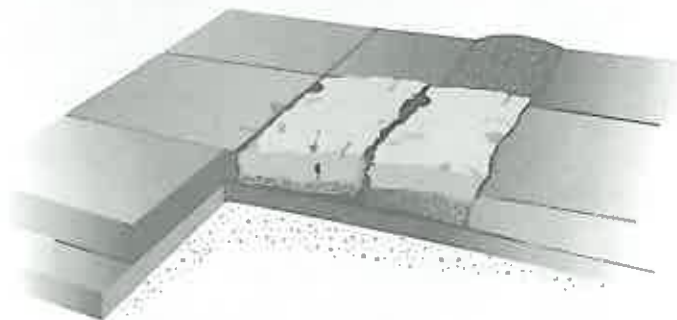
Zerstörung des unteren Betons, mit Ausknicken bzw. Ausbrechen des oberen Betons
